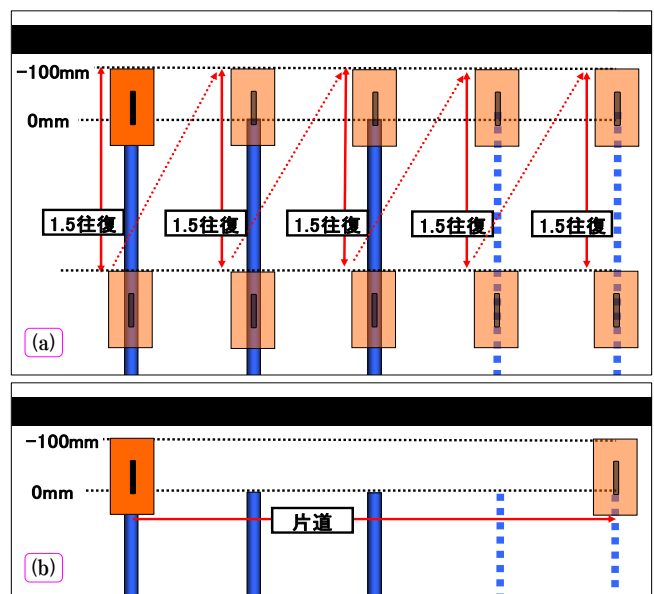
解析に用いた配筋モデル(鉄筋ピッチ 200 mm)
